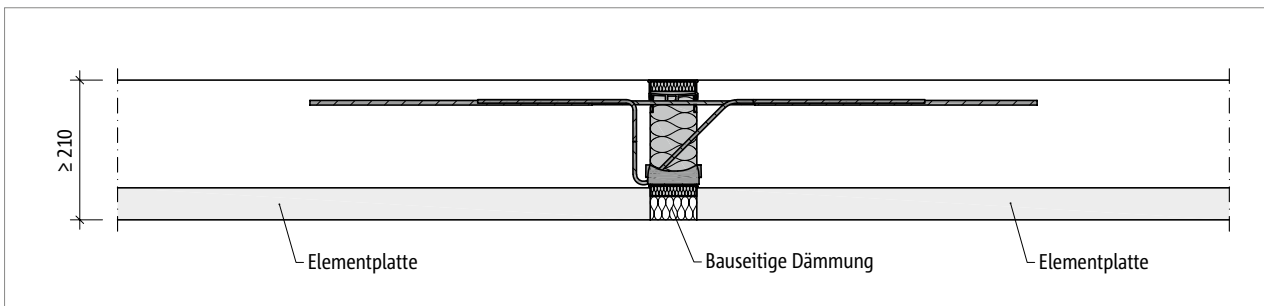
Schöck Isokorb® T Typ KL: Elementdecke mit aufgesetzten T Typ KL
